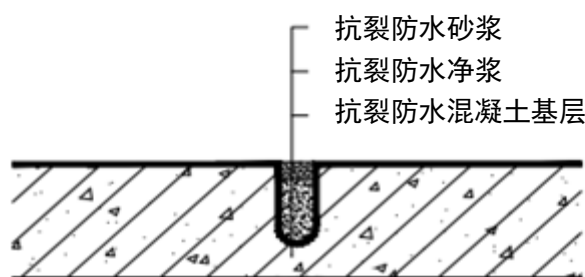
混凝土裂缝修补（开槽法）构造图
